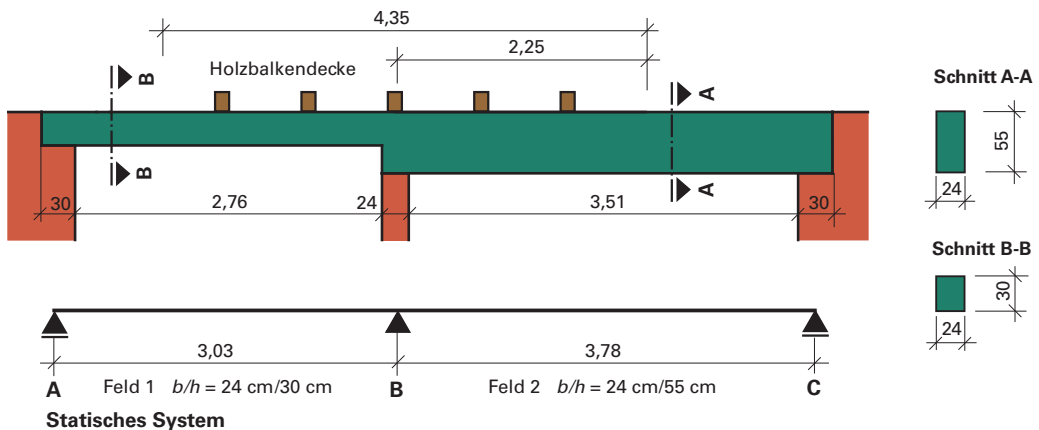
Stahlbetonbalken mit Rechteckquerschnitt
